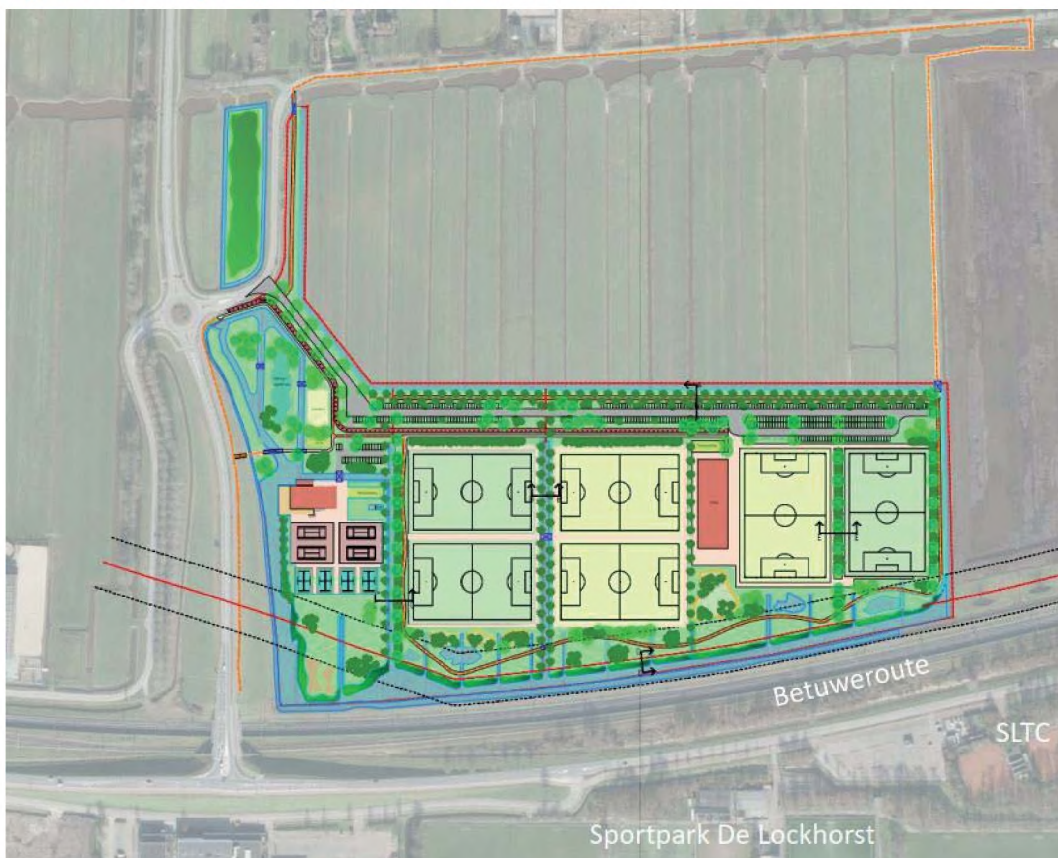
Ligging van locatie plan Sliedrecht Buiten
